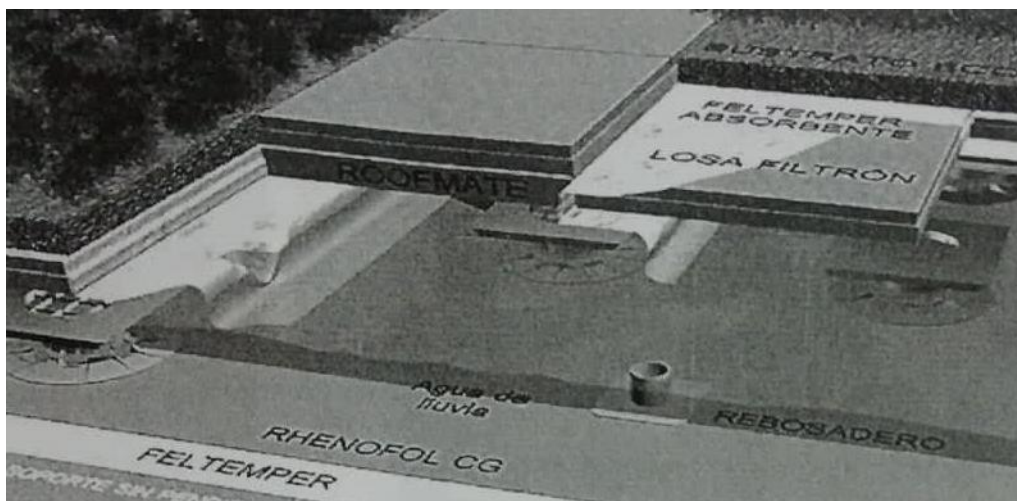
Detalle constructivo de la cubierta aljibe con vegetales.
